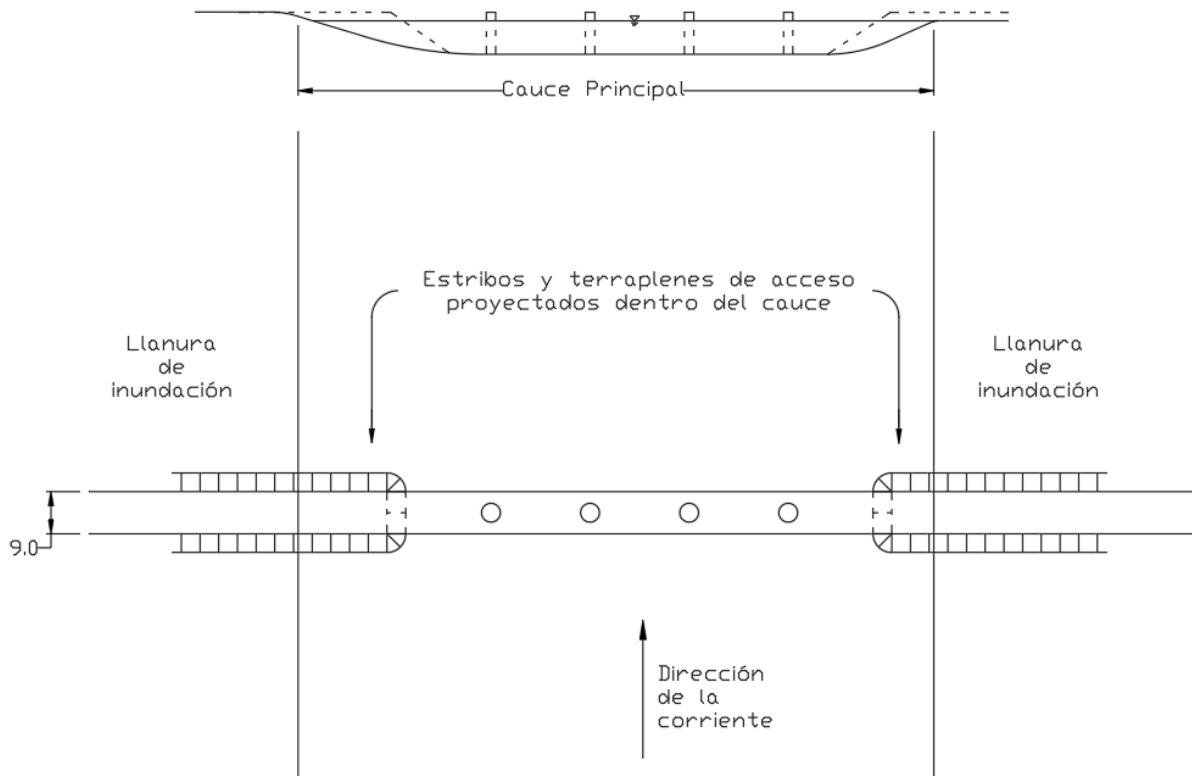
Vista en planta y sección transversal del río en donde se proyectó el puente.
